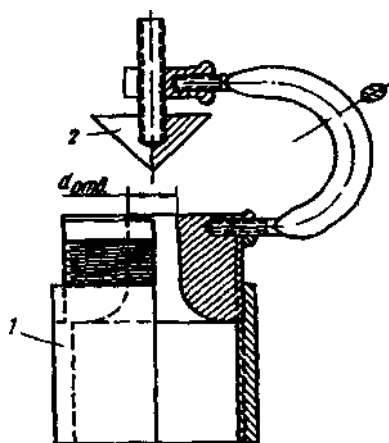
Спринклерная головка: 1 - корпус; 2 - отражательный зонтик
